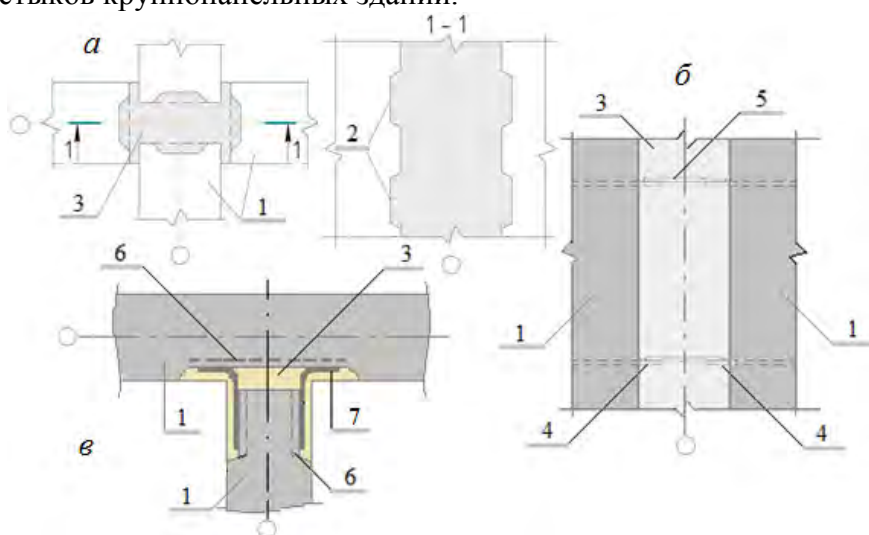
Варианты конструктивного решения стыков стеновых панелей: *а* – шпоночное соединение стеновых панелей, *б* – тоже со сваркой стальных арматурных выпусков, *б* – на закладных деталях с соединительными элементами в виде гнутых уголков (1 – стеновые панели, 2 – шпонки, 3 – замоноличенный стык, 4 – арматурные выпуски из стеновых панелей, 5 – соединительный стержень для сопряжения арматурных выпусков, 6 – закладные детали стеновых панелей, 7 – соединительный элемент в виде гнутых уголков)
